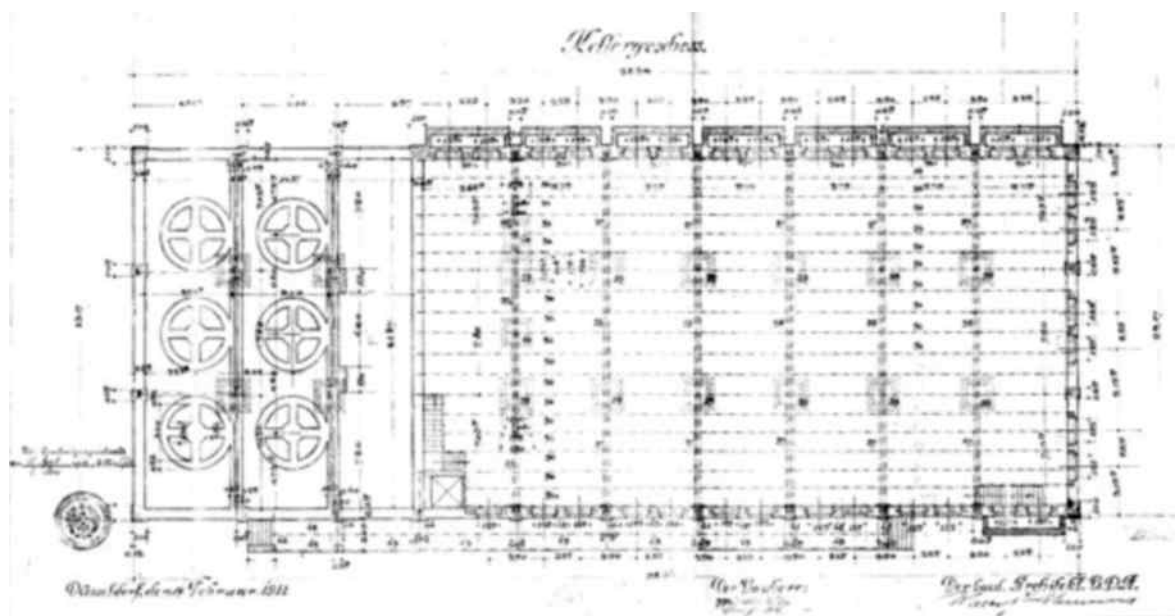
Neubau Seifenpulver-Fabrikgebäude Geb. C 02, 1911, Kellergeschoss – Architekt: Walter Furthmann
